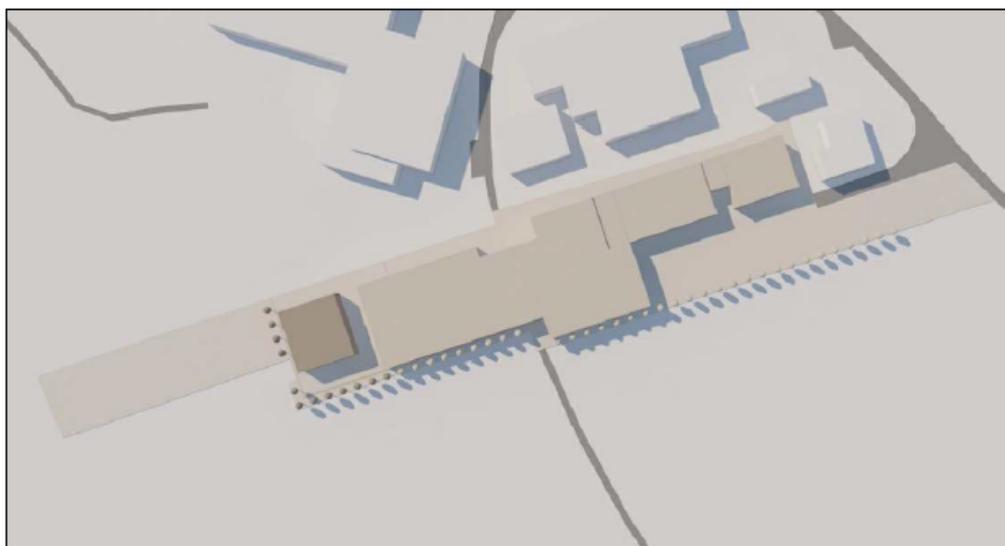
Render volumetrico – Vista aerea planimetrica dell'intervento
